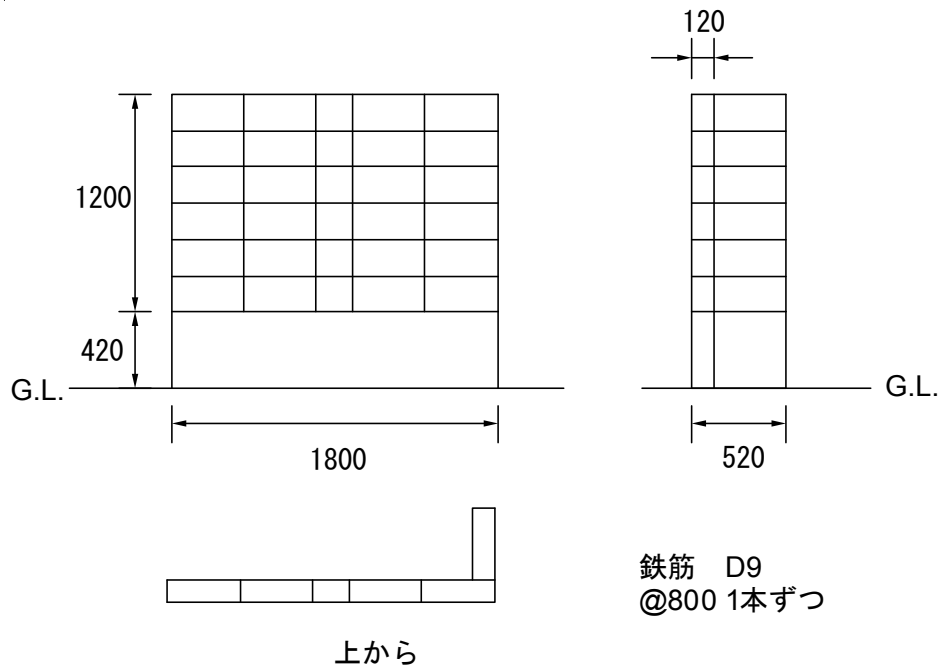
CB 塀立面図 (単位 : mm)
